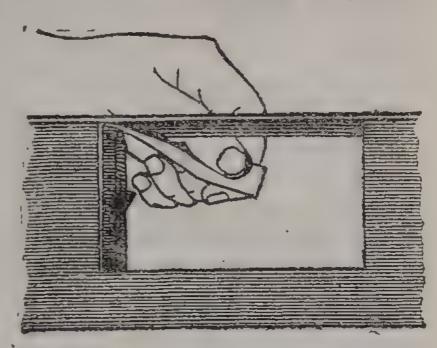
Проверка прилегания бревой личинки к крышке короба
